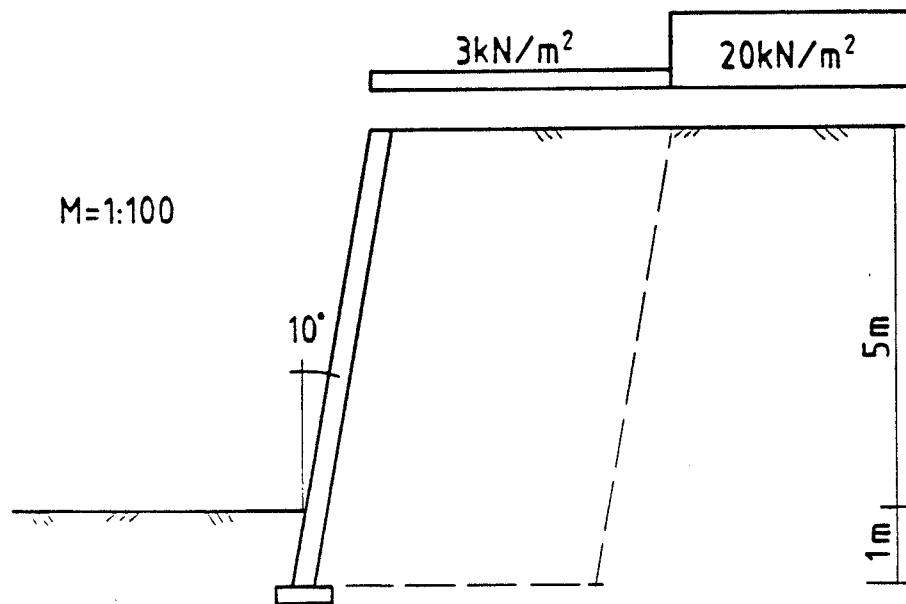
STØTTEKONSTRUKSJON I ARMERT JORD
